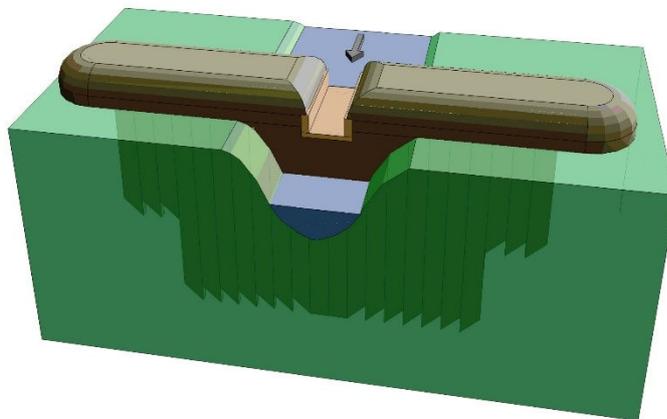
Aufbau einer einwandigen Holzspundwand, nach der Überwallung mit Torfen.
